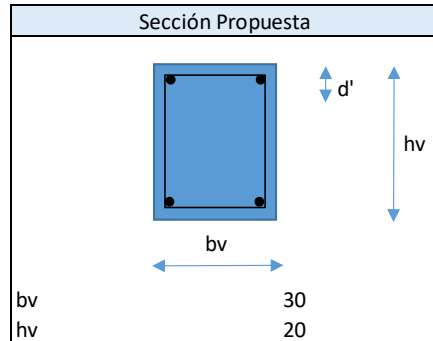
Vigas de cimentación medianeras ejes A2,A3,C2,C3
